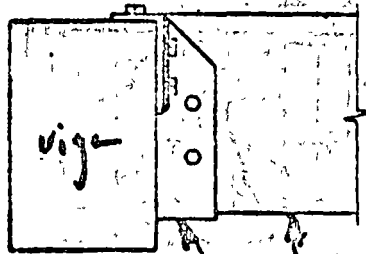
DETALLES DE APOYO Y ANCLAJE DE VIGAS EN CONCRETO O MAMPONERÍA
